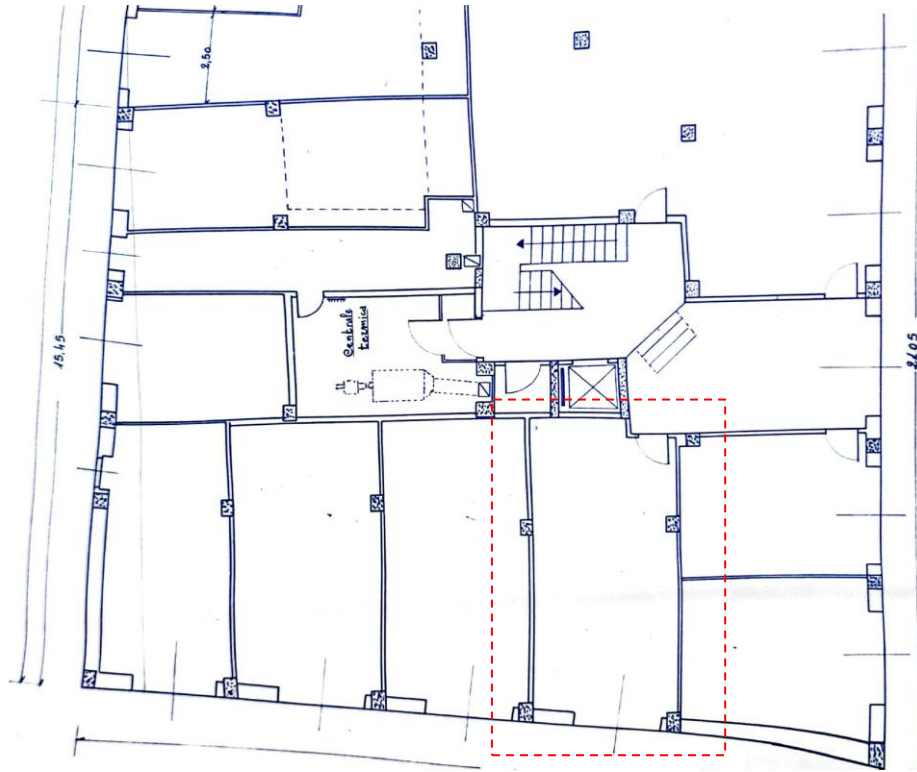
planimetria allegata alla Licenza Edilizia n.1972 del 14/04/1966
